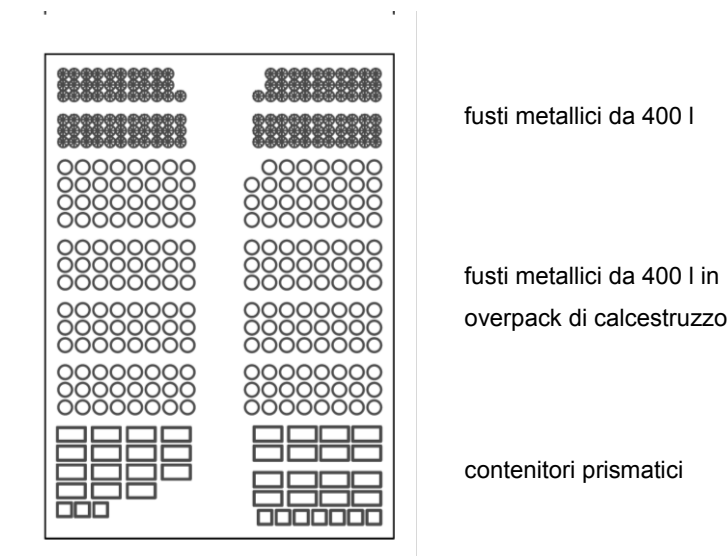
Dimensioni in pianta e piano di caricamento preliminare.
